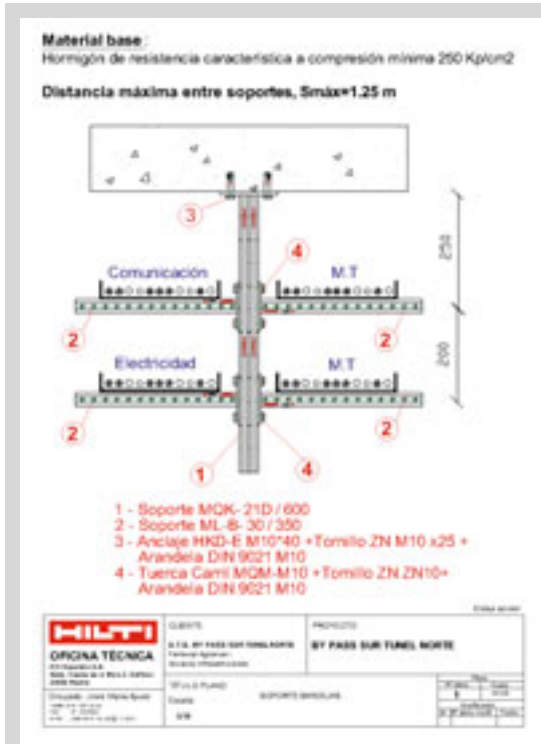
Cálculo del soporte utilizado para las bandejas.
